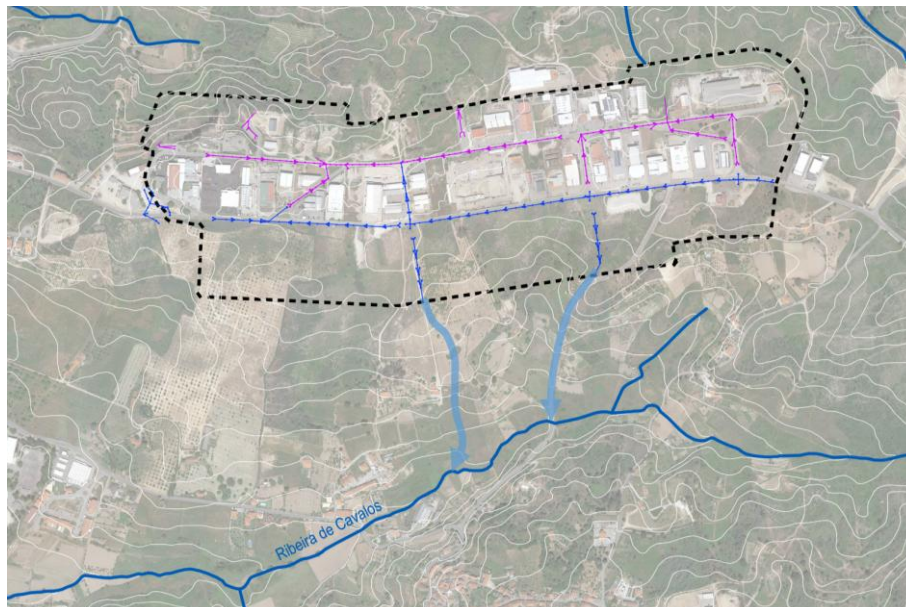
Representação da Planta de Infraestruturas – Rede de drenagem de Água Pluviais
